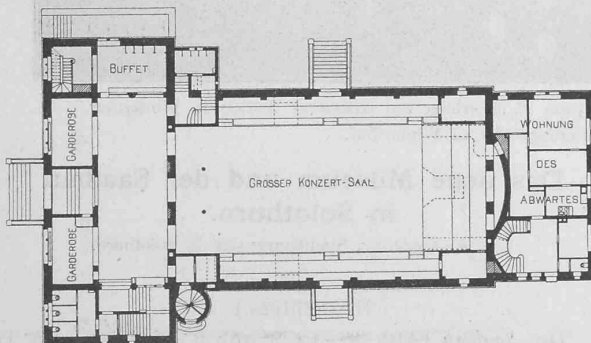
Saalbau. — Grundriss vom Erdgeschoss. — 1 : 600.
